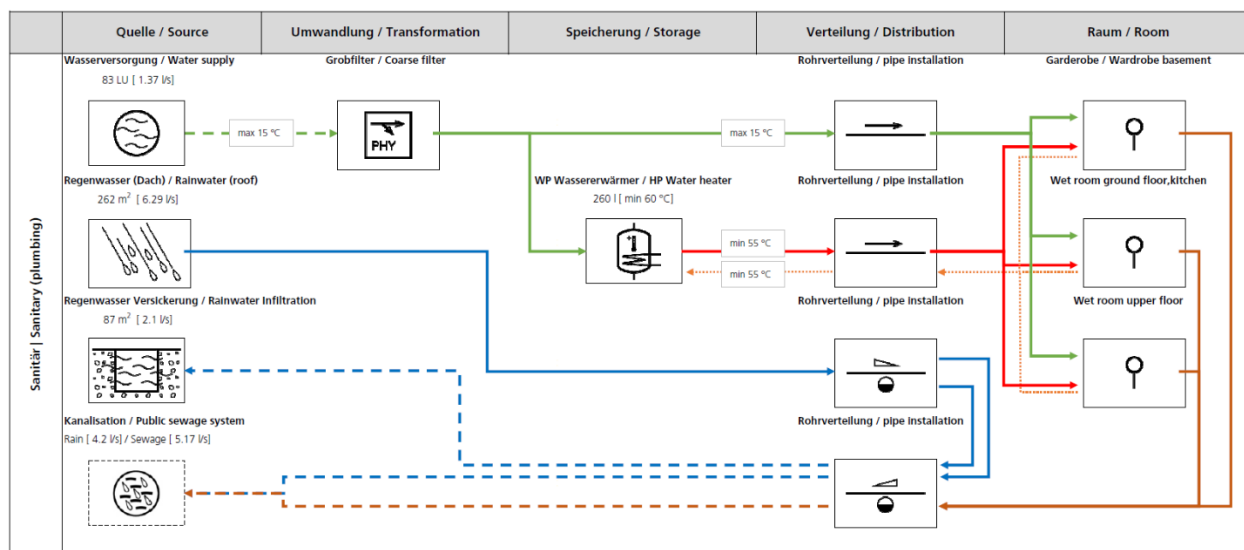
SIA 411 Modules installations techniques – Sanitaires
